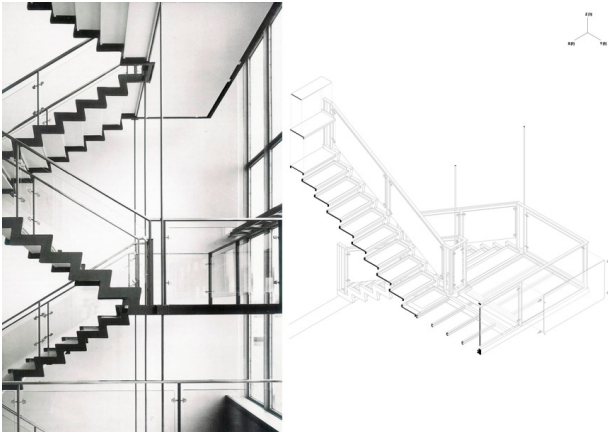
Detalle constructivo en axonométrico y fotografía lateral de la escalera. 1957. Architectural Records, Building types study.
